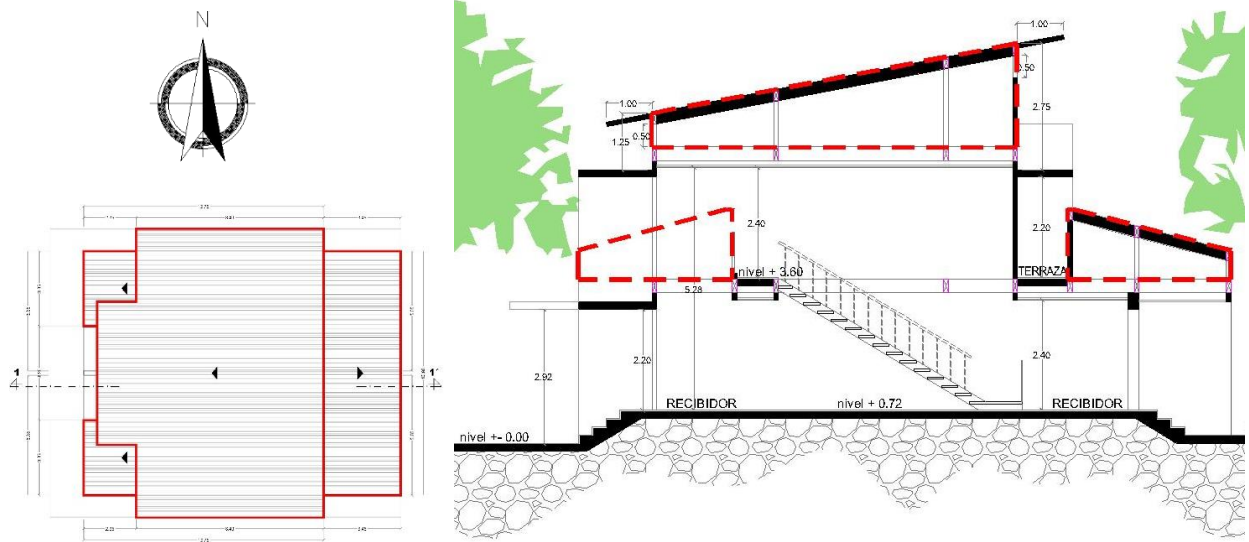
Señalización de las cubiertas inclinadas ventiladas en planta y corte.
